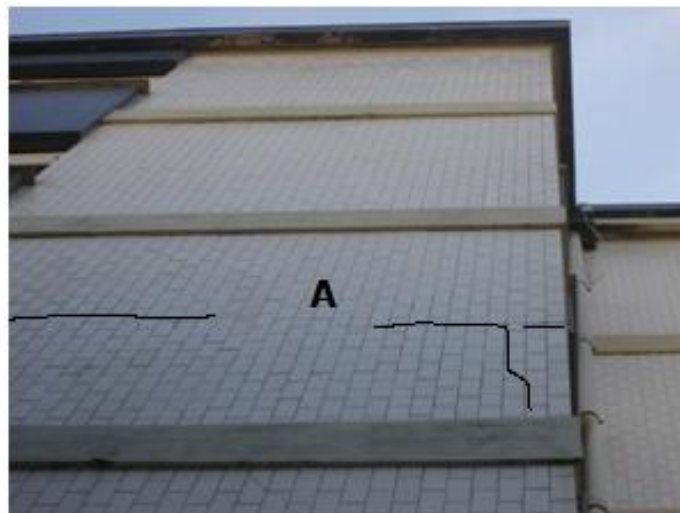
Fissuras/Fendas horizontais no avançado “A”
